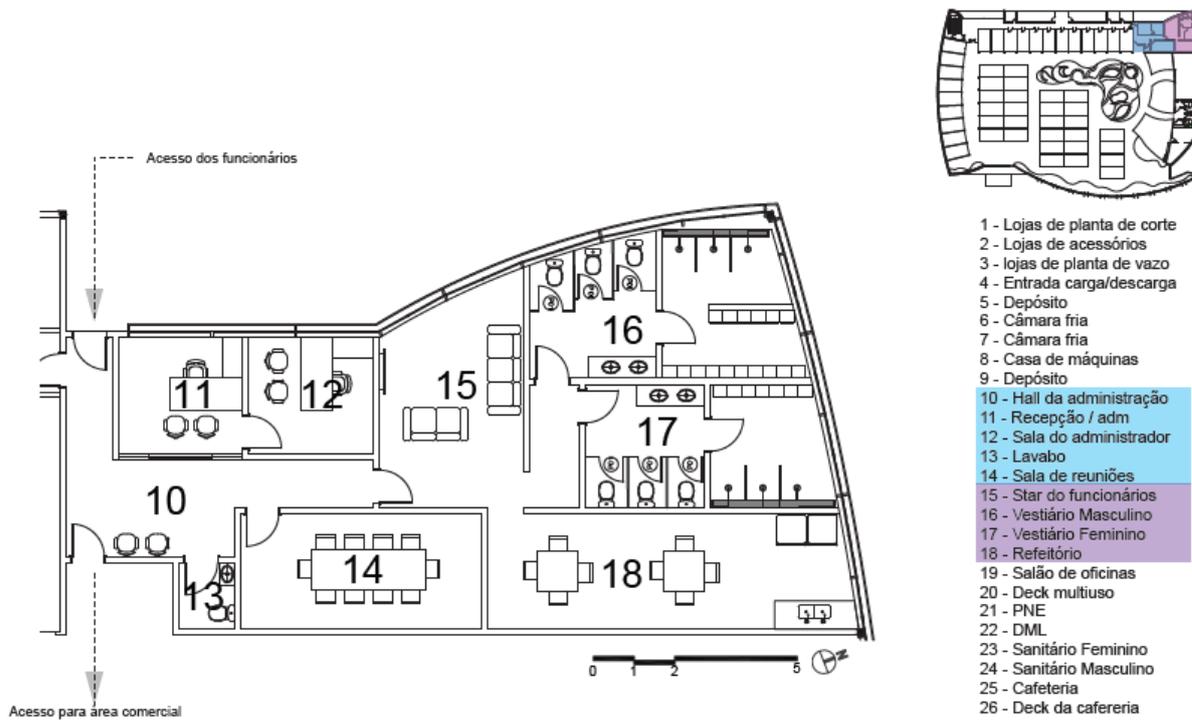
Planta Baixa (Setor adm.). Fonte: Acervo do autor.
